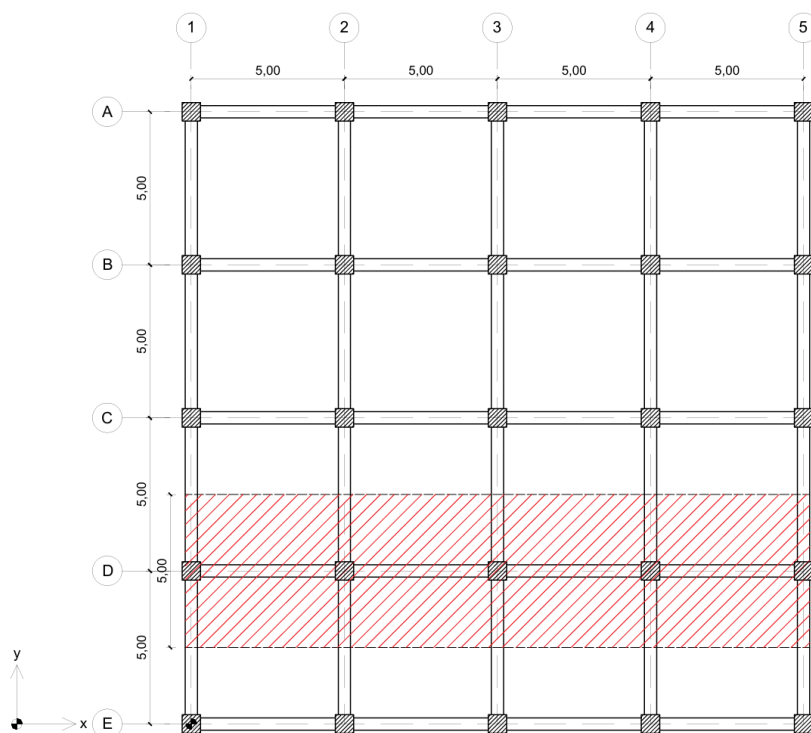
Planimetria strutturale dell'edificio con focus sul telaio analizzato (quote espresse in metri)
